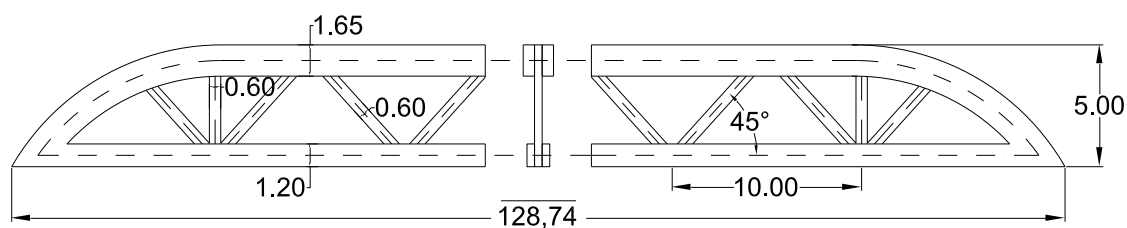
Representação da viga principal em corte longitudinal (distâncias em [m])
